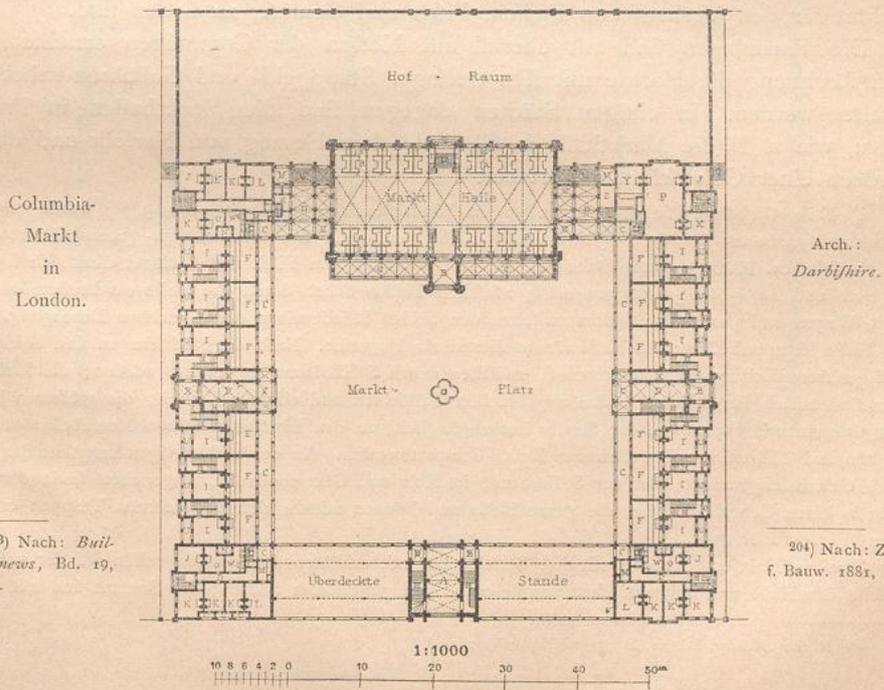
Grundriss<sup>204)</sup>.
